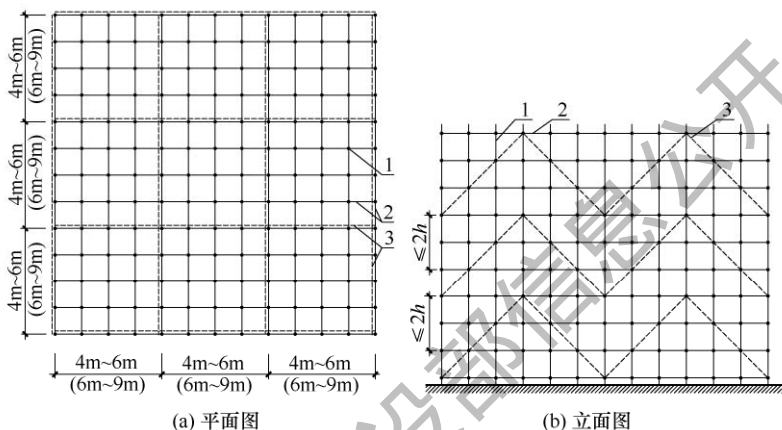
竖向斜撑杆布置示意图 (二)
